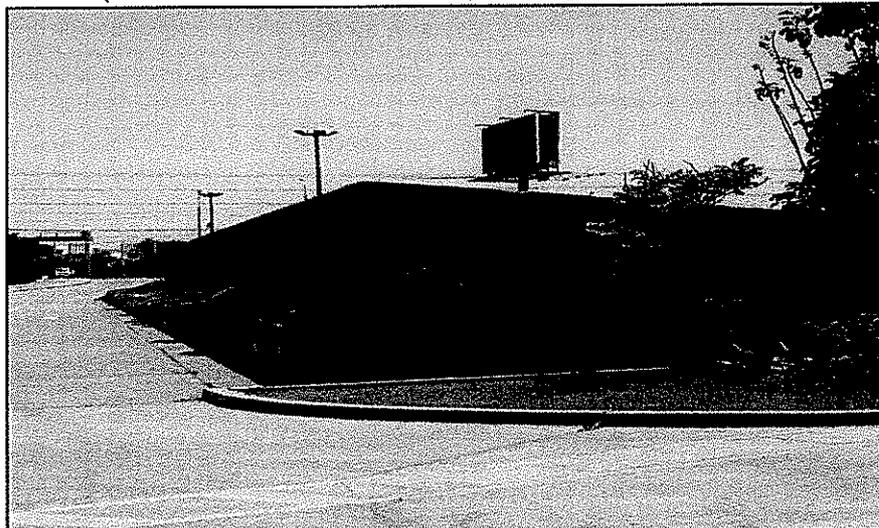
Vista del área donde será intervenido por el proyecto (Área proyectada para la Nueva Edificación)
